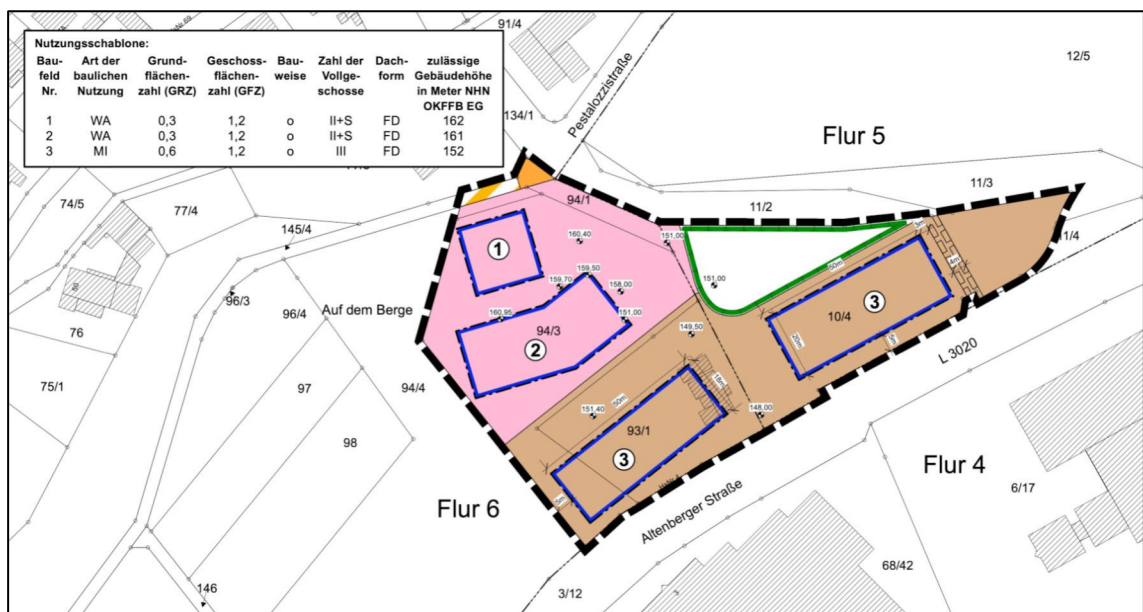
Planteil des Bebauungsplans - Ausschnitt
